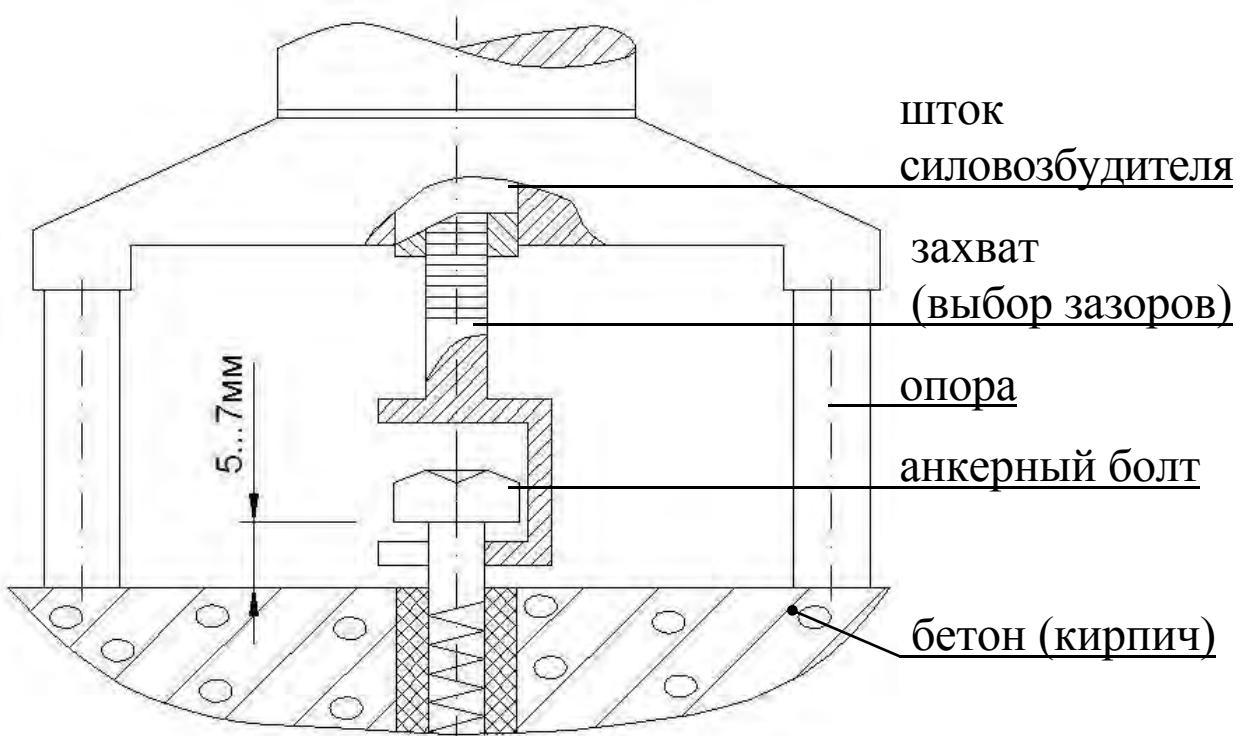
Схема подготовки прибора ПСО-МГ4А к измерениям
